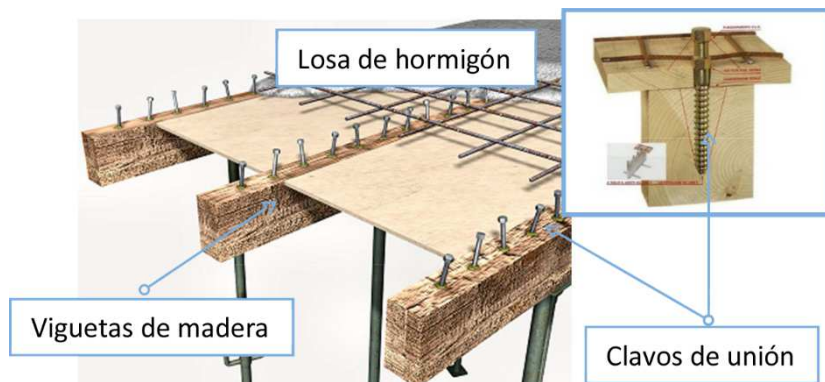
Esquema de refuerzo de un forjado de viguetas de madera mediante una losa de hormigón. Fuentes: http://www.generadordeprecios.info/rehabilitacion/Estructuras/Madera/Refuerzos/EMZ310_Refuerzo_de_forjado_de_madera__medi.html. <http://www.al-fer.it/wms/default-1.htm?iID=EDDGHHD>.
